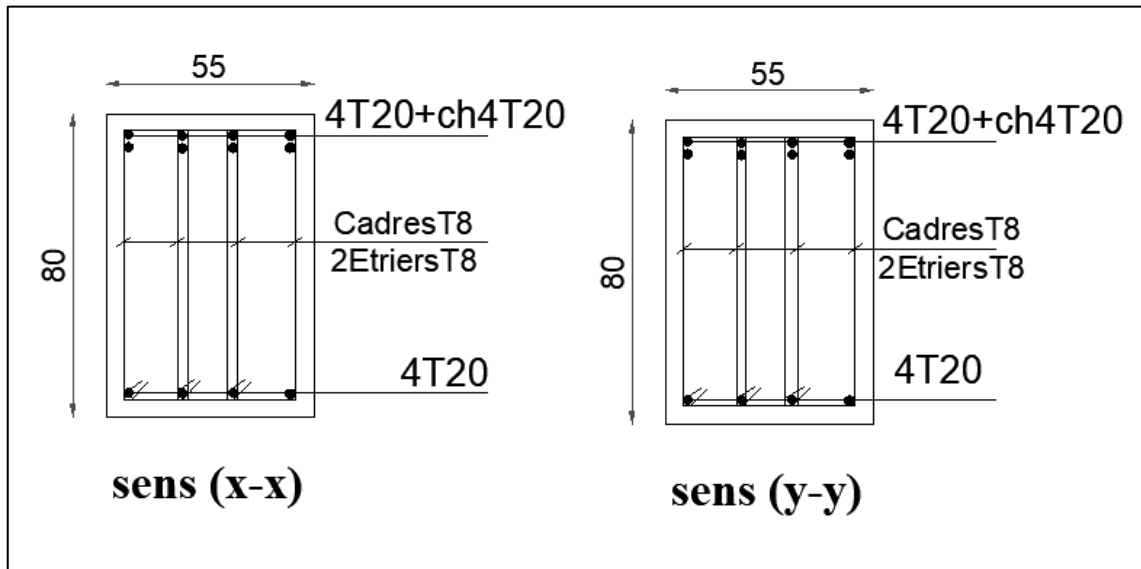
Ferrailage Nervure sur travers de sens (x-x) et sens (y-y).
